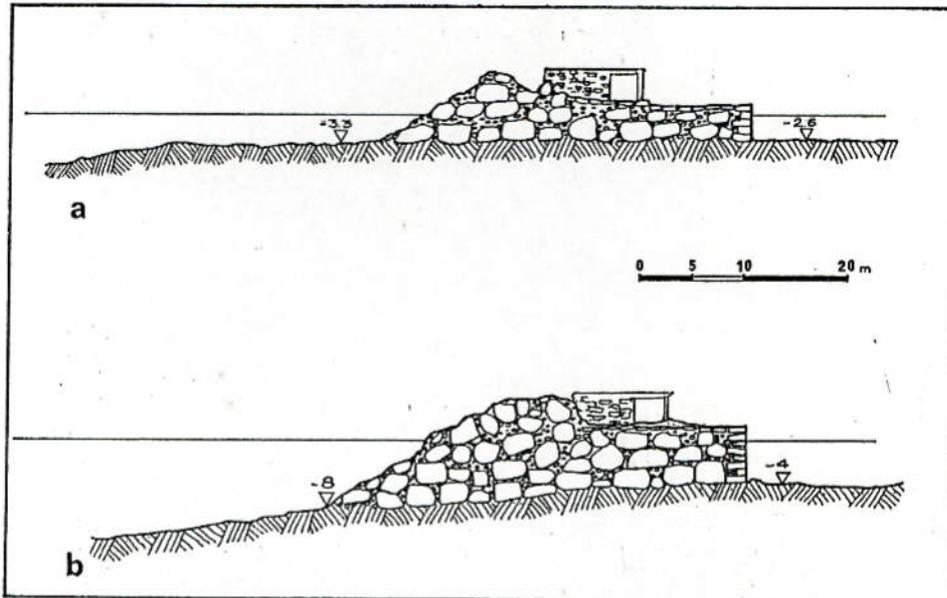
CÉSARÉE; coupe de la jetée, avant (a) et après (b) affaissement.
